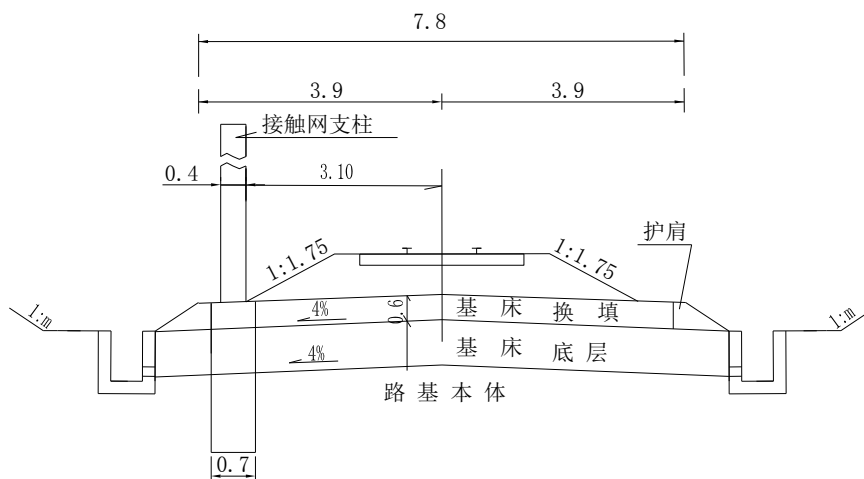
一般地段路堑标准横断面示意图 (m)
